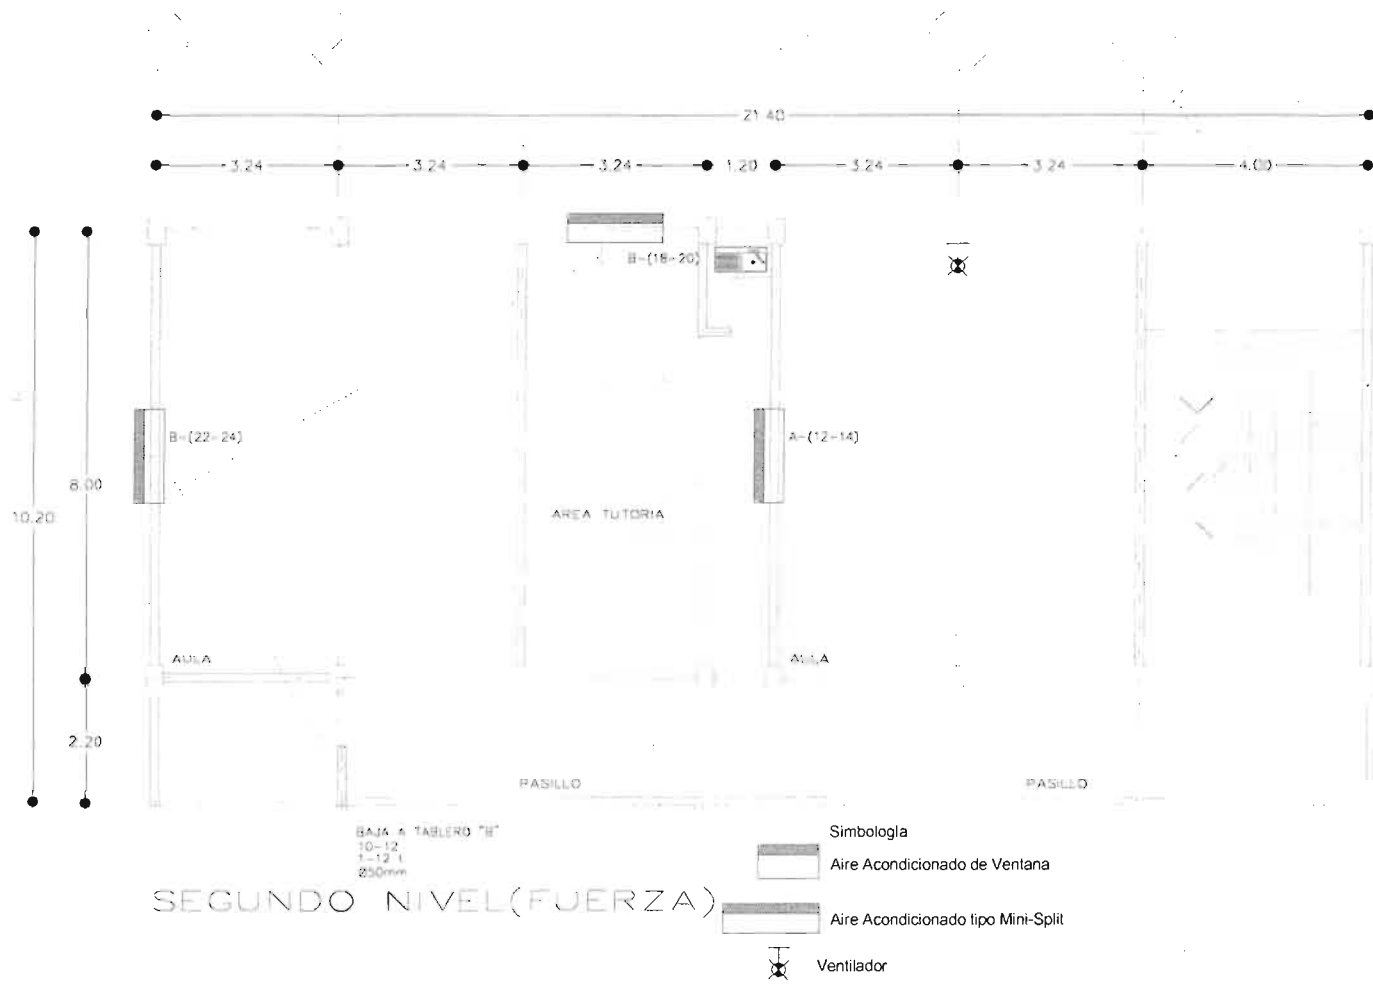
Plano de Aires de la Segundo Nivel del Edificio B.
